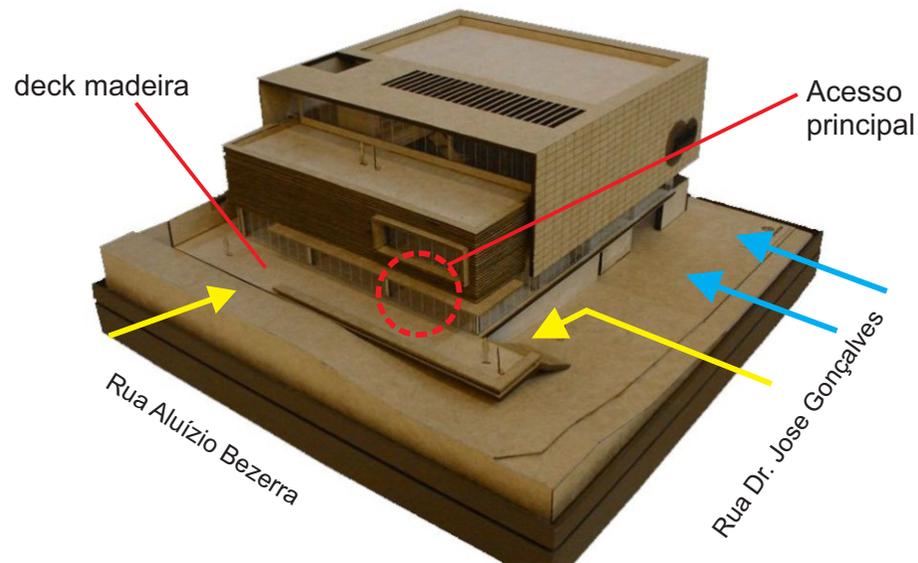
Maquete projeto. Fonte: Site Archdaily
